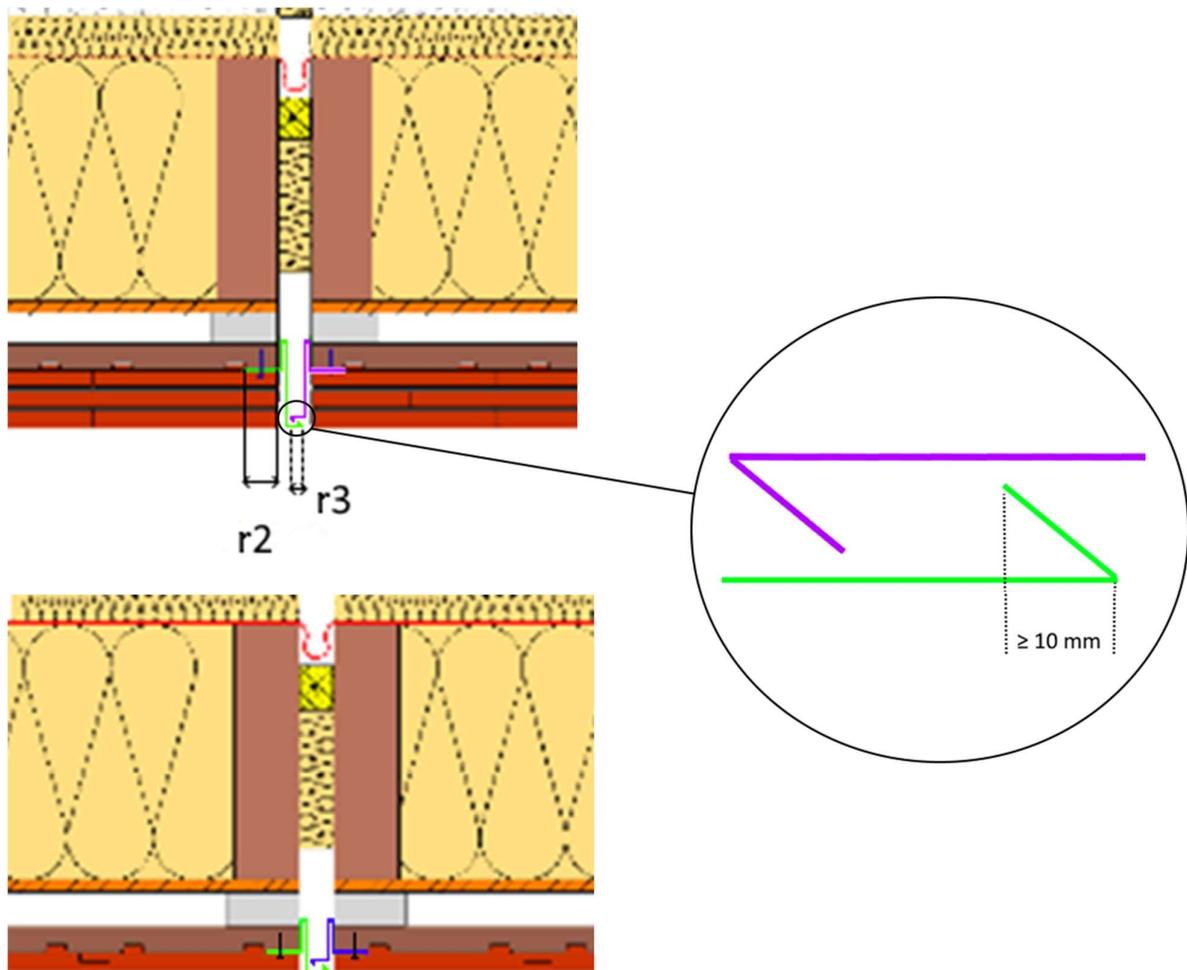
Détail du traitement du joint de dilatation avec profilés métalliques avec zoom sur pli des profilés
